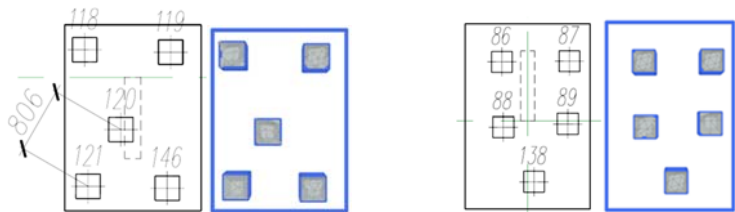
Схема смещения свай в плане на исполнительную (верх) и в расчетной схеме (низ)
